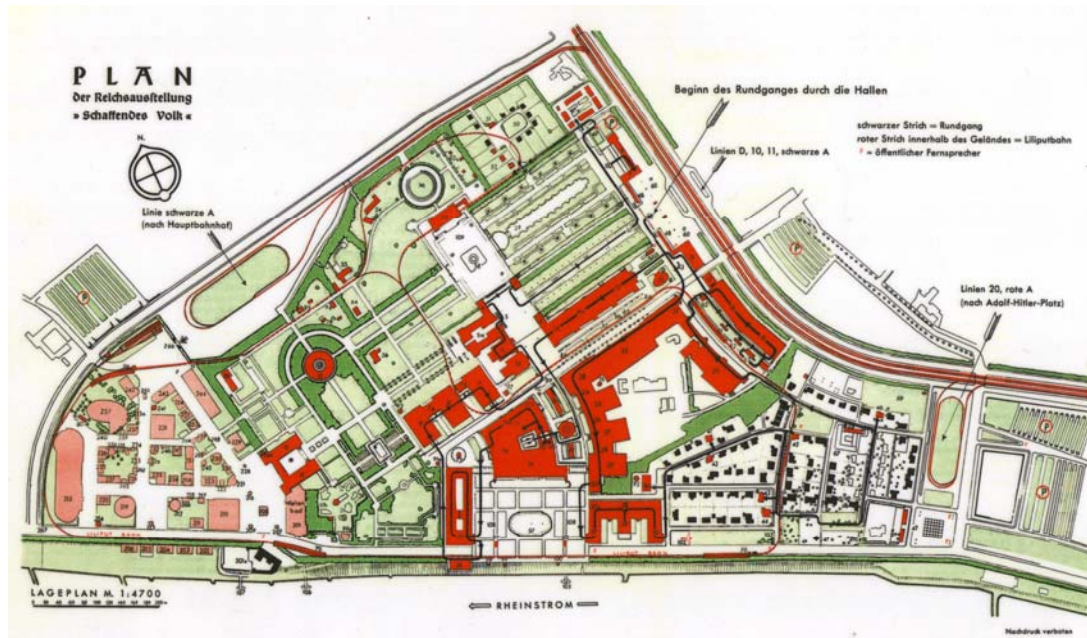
Lageplan der Ausstellung SCHAFFENDES VOLK, 1937
